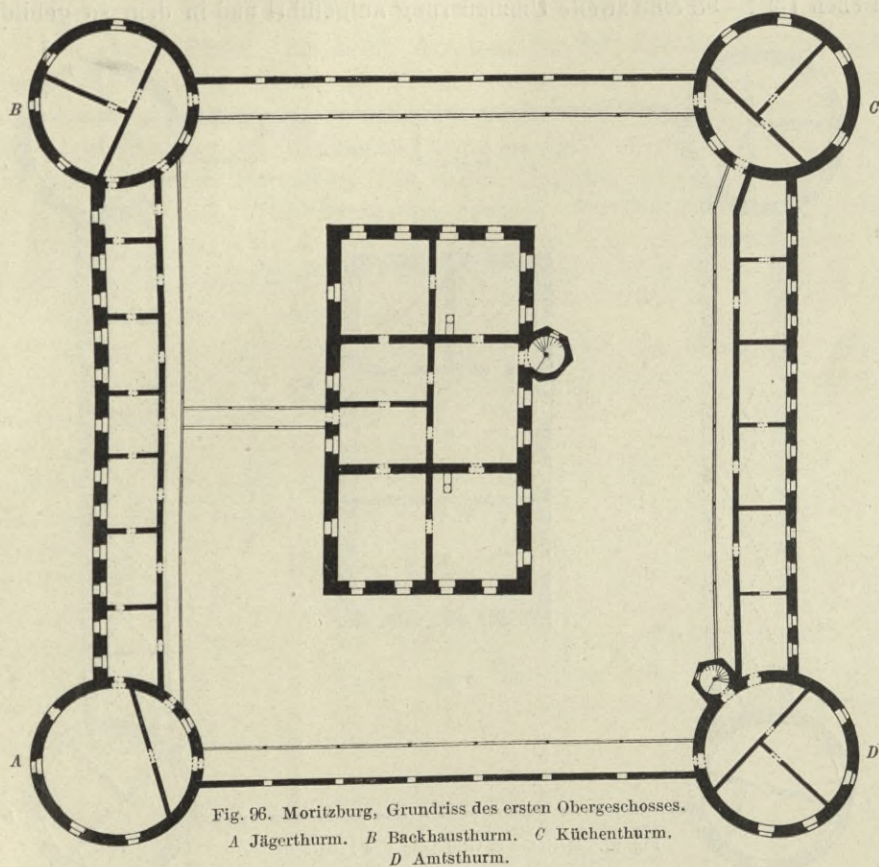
Moritzburg, Grundriss des ersten Obergeschosses.
